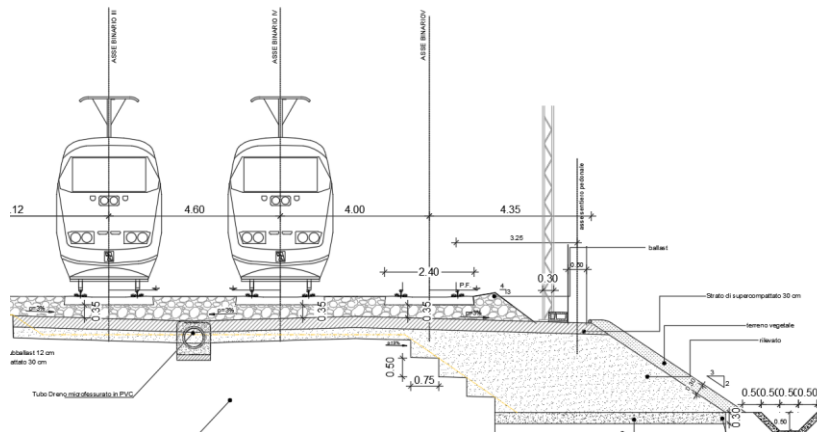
posizionamento della tubazione drenante sotto i binari III e IV
